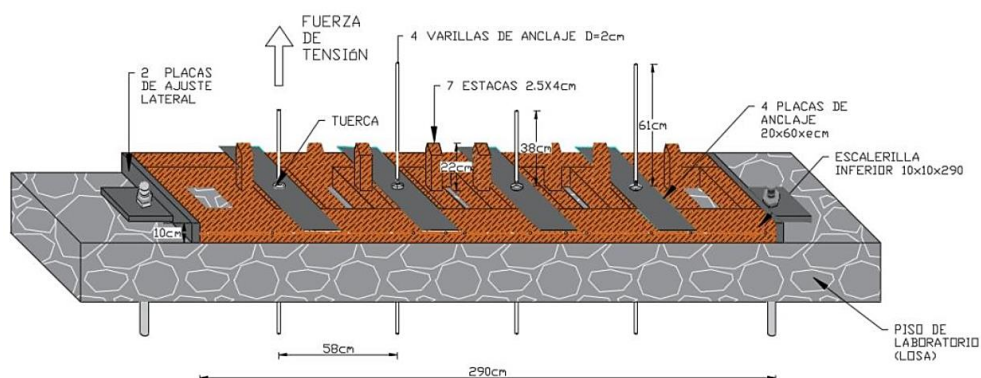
Detalle de anclaje de la cimentación de los muros ensayados
